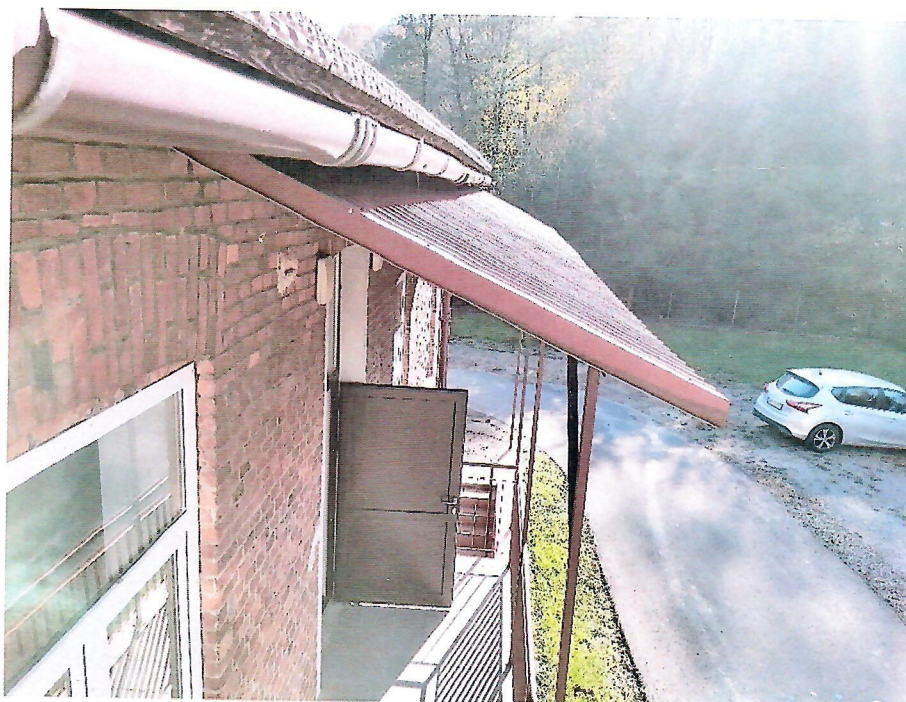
Widok dachu od strony północnej. Brak widocznych ugięć połaci dachu.
